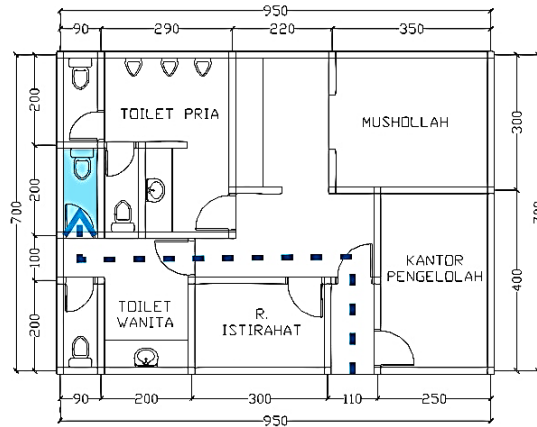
Denah Toilet Pada Segmen A (D 1.1)
